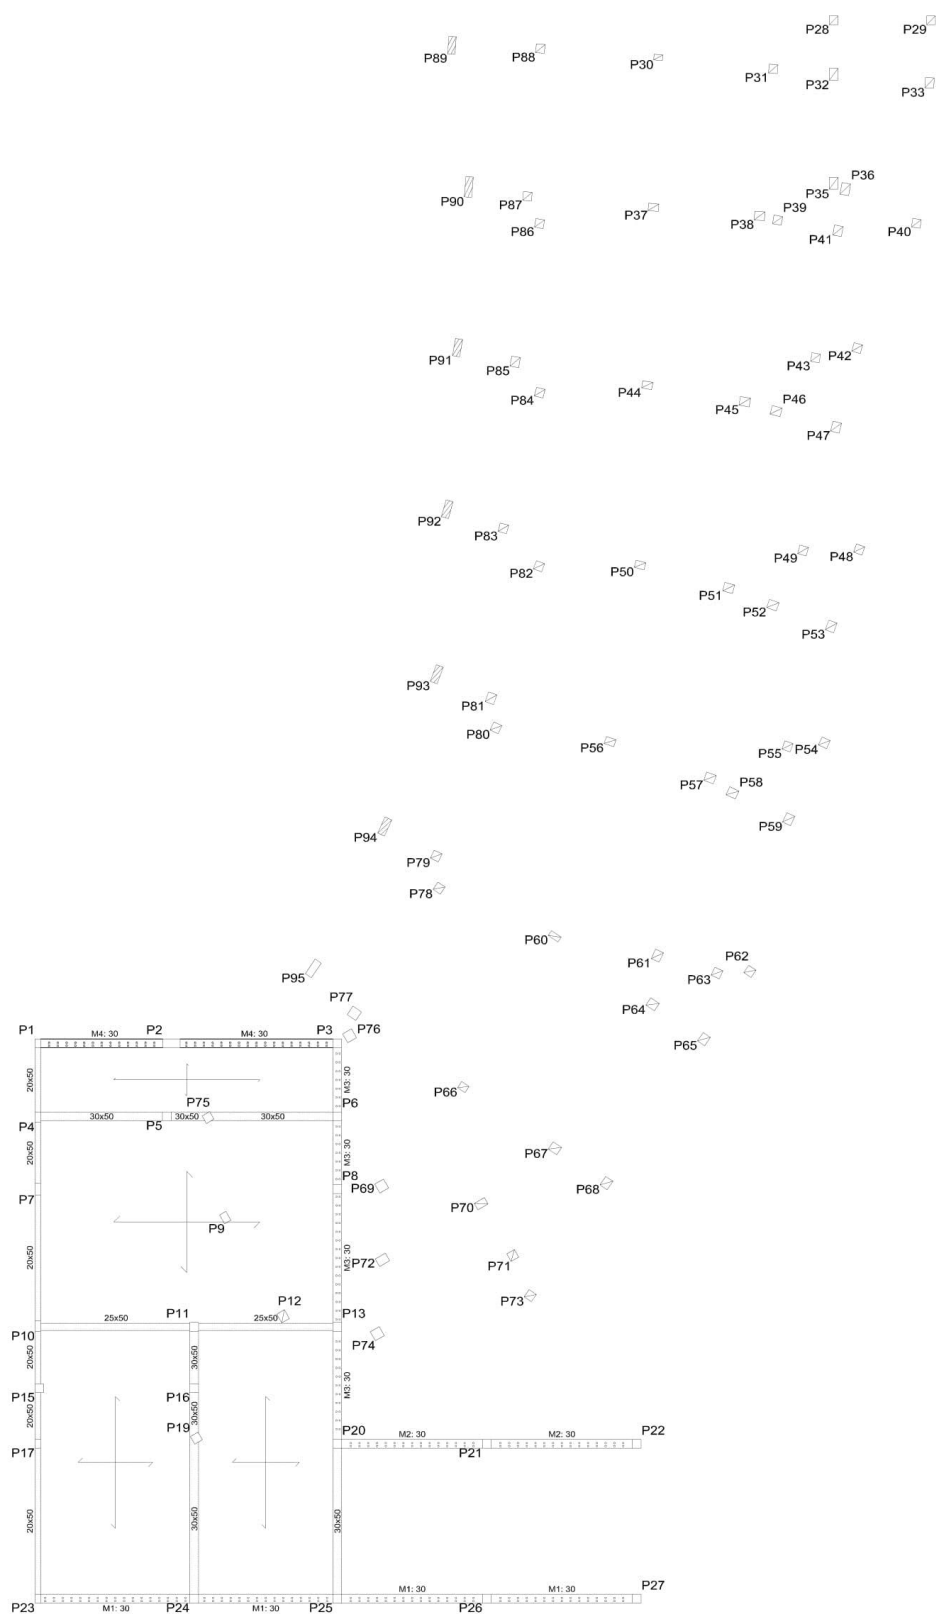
Planta estrutural do Rés-do-Chão: corpo F (s/escala).
